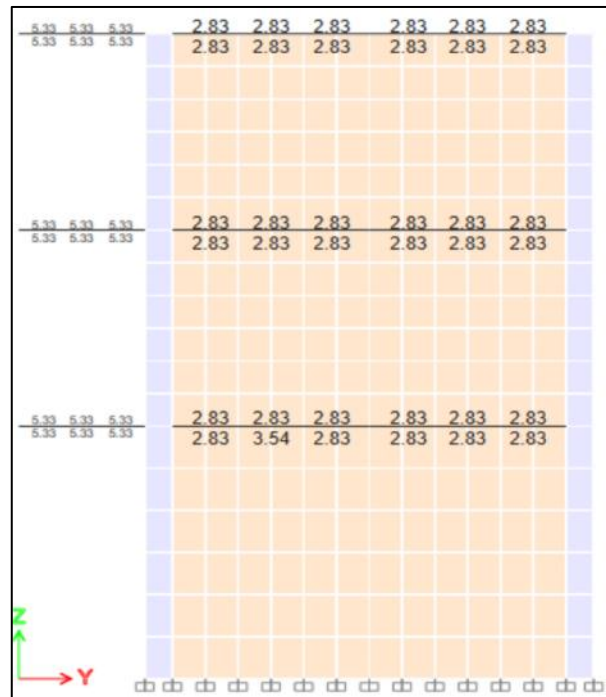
Refuerzo longitudinal en vigas (30x50)-ESC.
